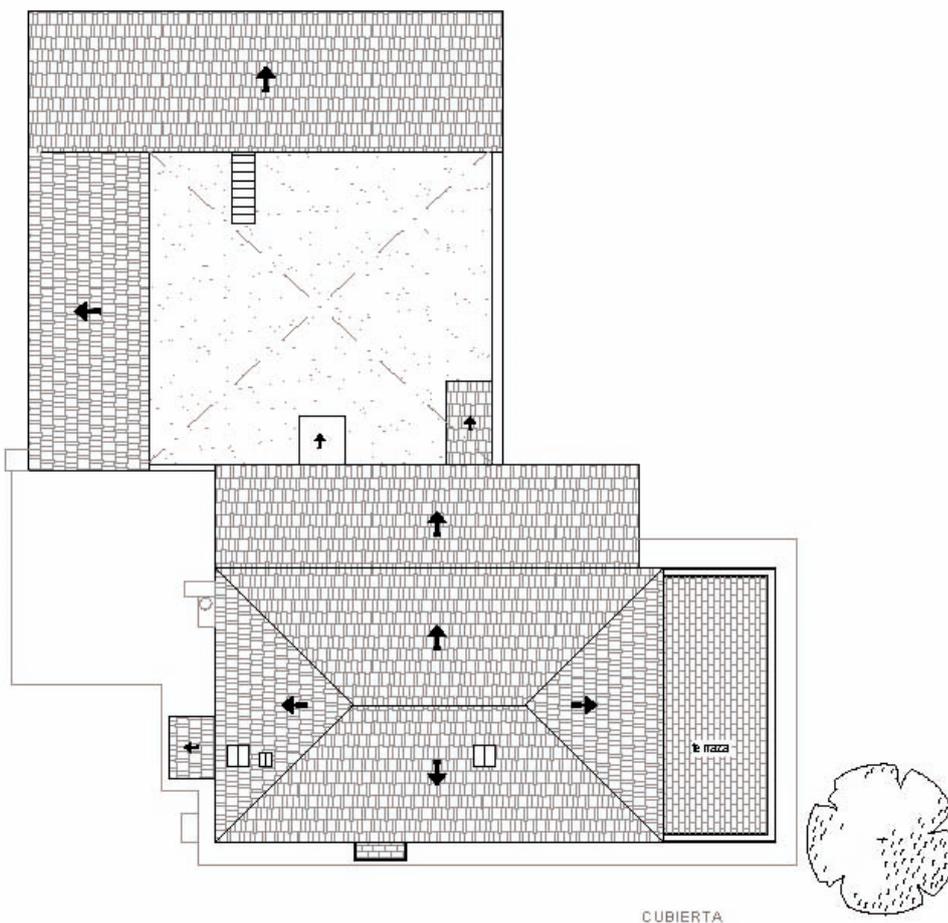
Plano de planta de cubierta Caseta Bas. Fuente Propia. 2016
